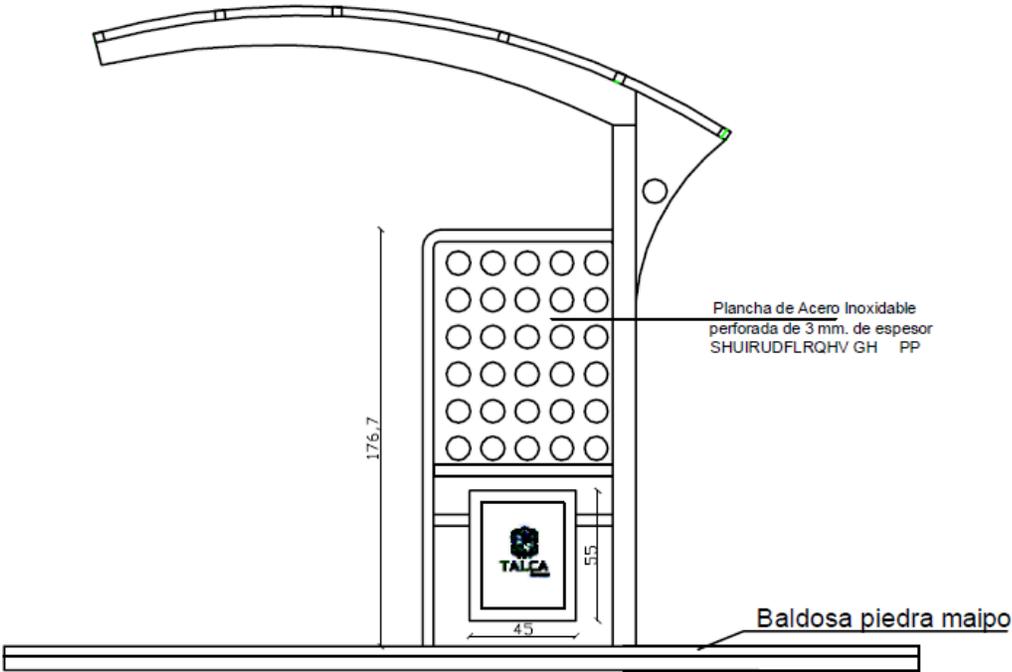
Dimensiones Pre-diseño del paradero Simple, Planta
